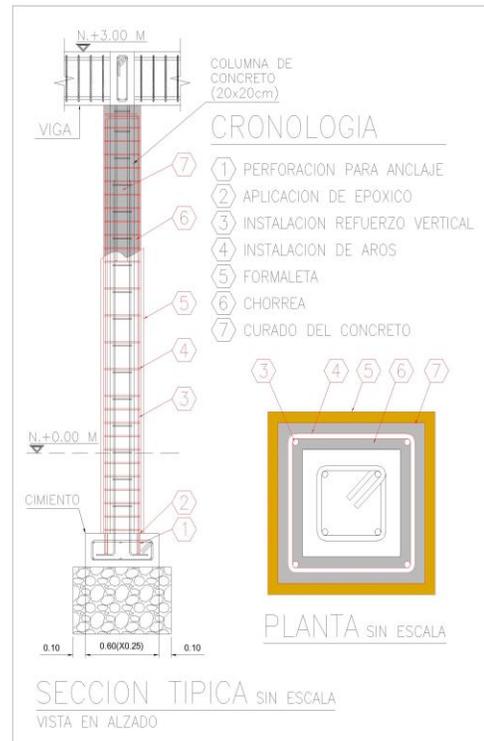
Vista en alzado de la columna con refuerzo por anillo perimetral. Autocad 2005.
